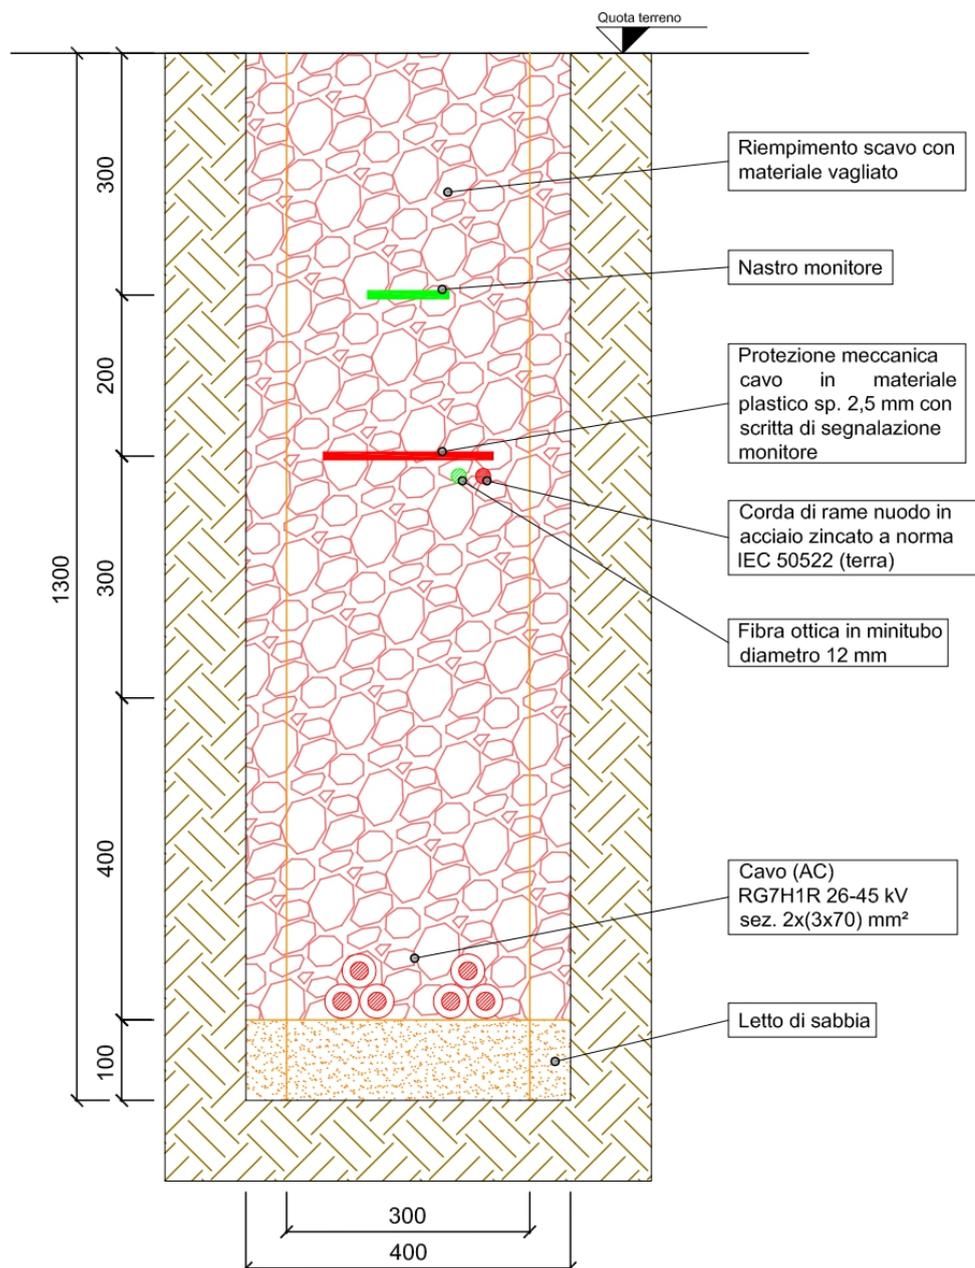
Tipico sezione di posa con due cavidotti interni da 3x70 mm²
